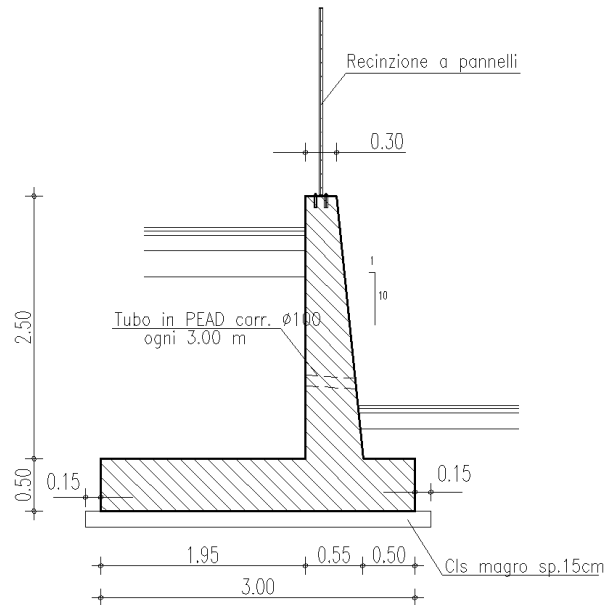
Sezione trasversale muro di contenimento H = 2.50 m
